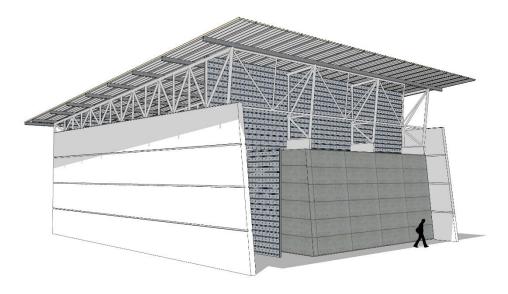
Maqueta Virtual. Tipología de Coliseo con tratamiento de fachadas ventiladas. Fachada Nor-
